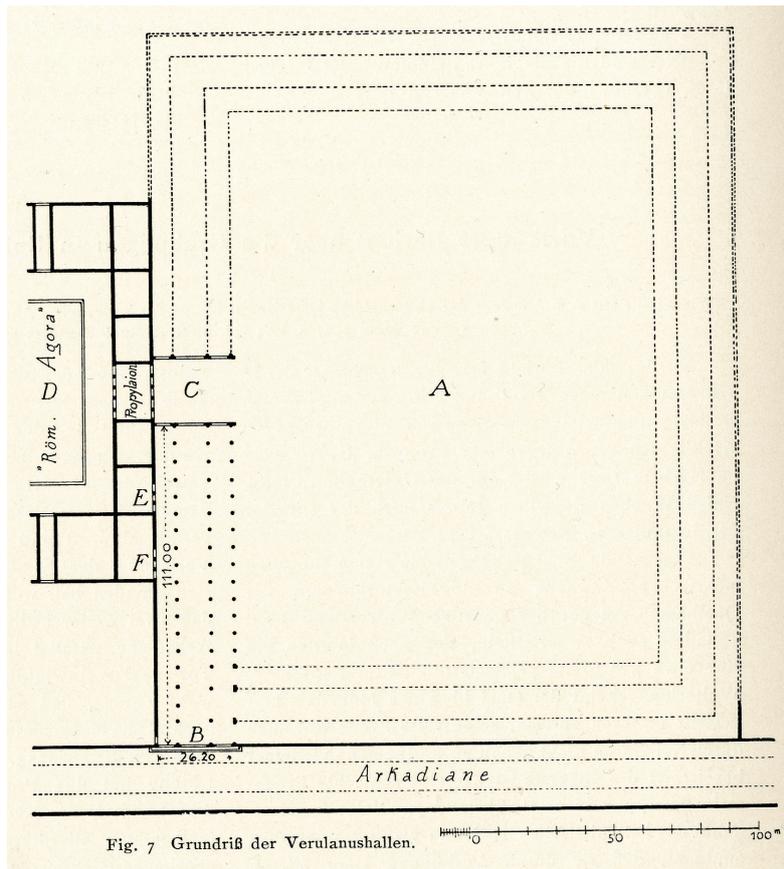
Grundrissplan der Verulanushallen von Heberdey 1904
